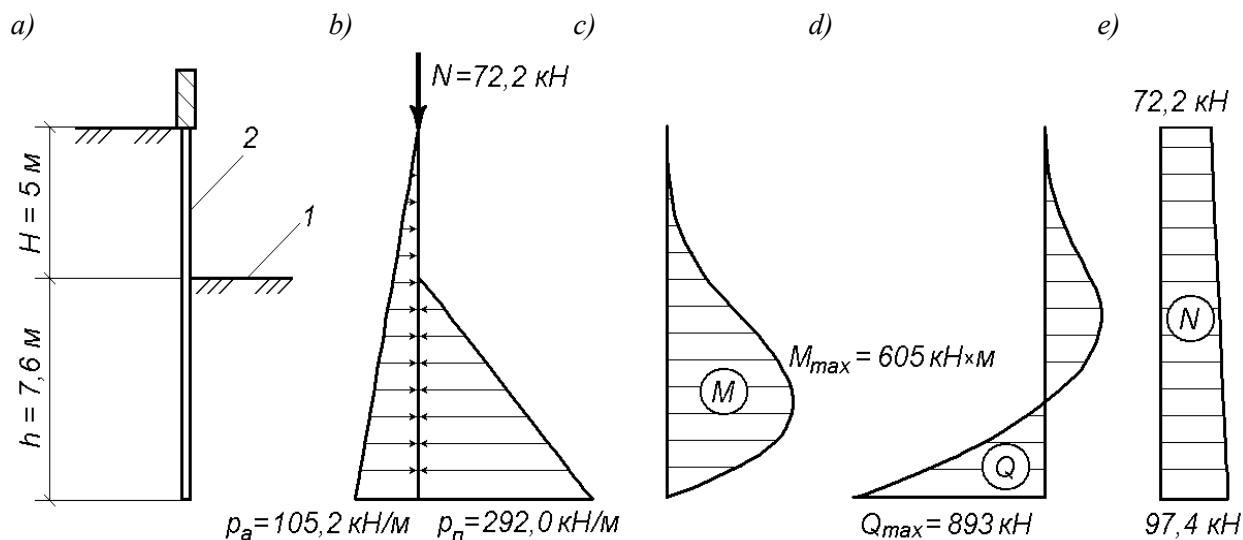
Крепление стенок котлована шпунтовым свайным рядом без анкеровки:
